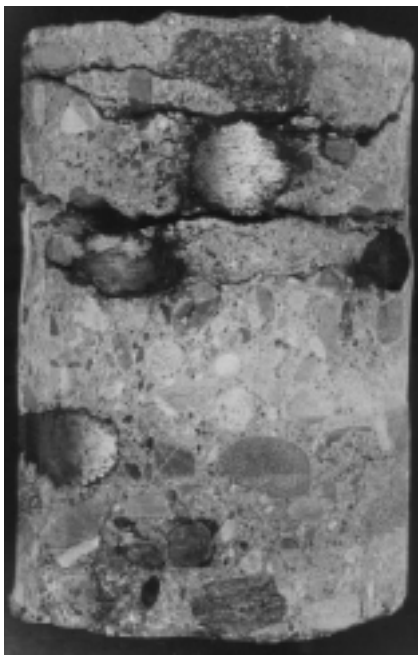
Bohrkern durch die Ortbetondecke eines Parkhauses; Rissbildungen (Abplatzungen) parallel zur befahrenen Oberseite infolge Bewehrungsstahlkorrosion.
